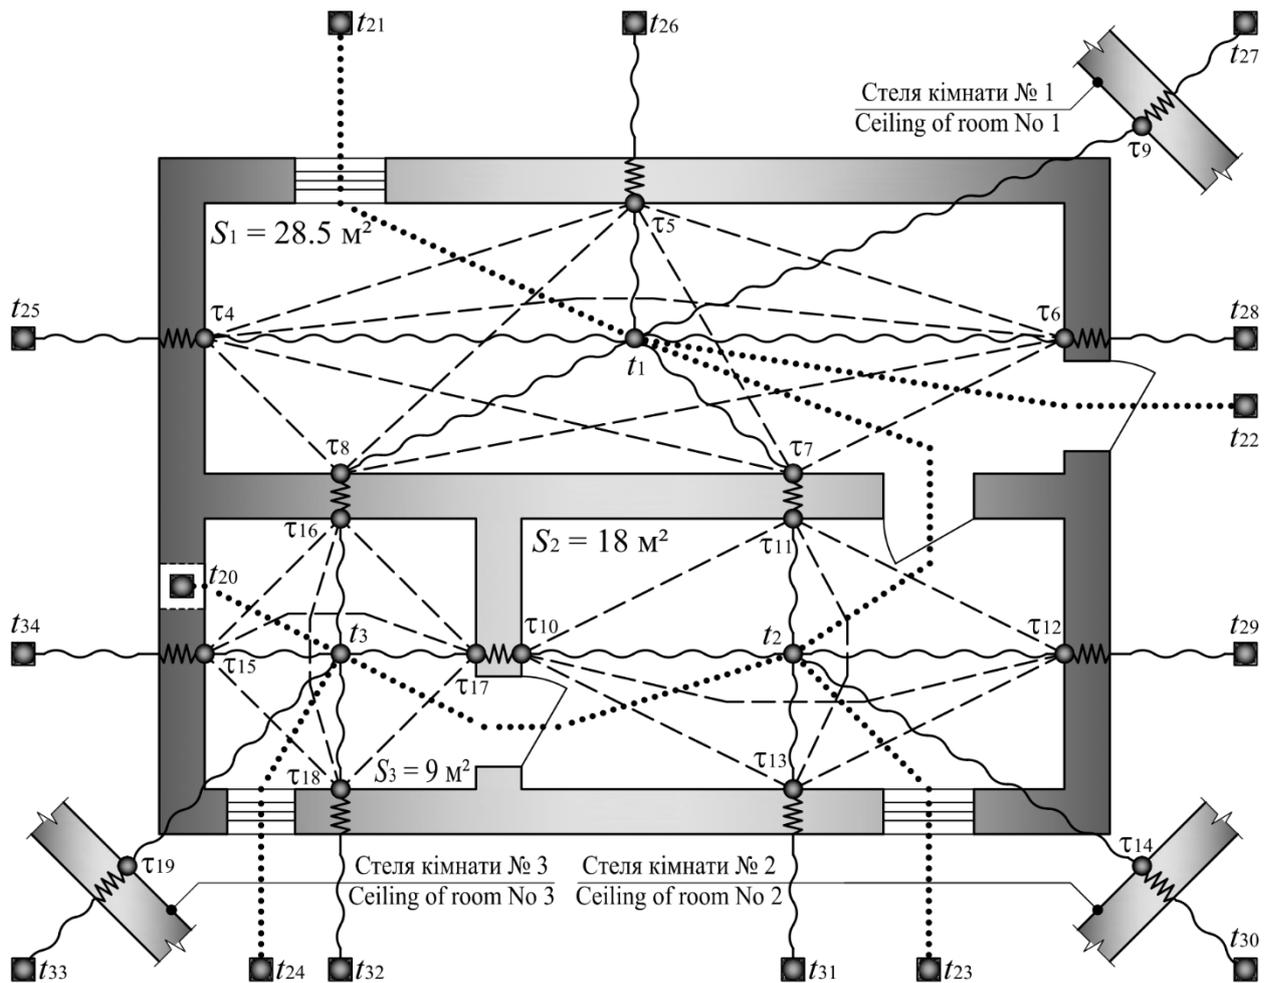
План досліджуваної будівлі та дискретна розрахункова модель теплообміну у ньому.
